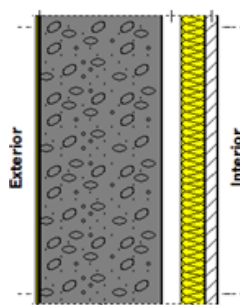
Pormenor de muros em contacto com o terreno – Par\_Ext\_Cave\_1.
